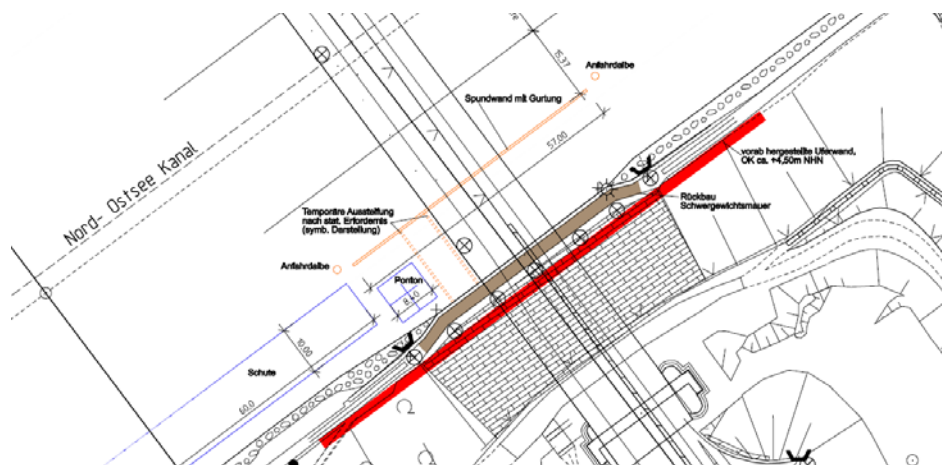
Rückbau Notfundamentreste unter Wasser mit Sicherungswand (Grundriss)
